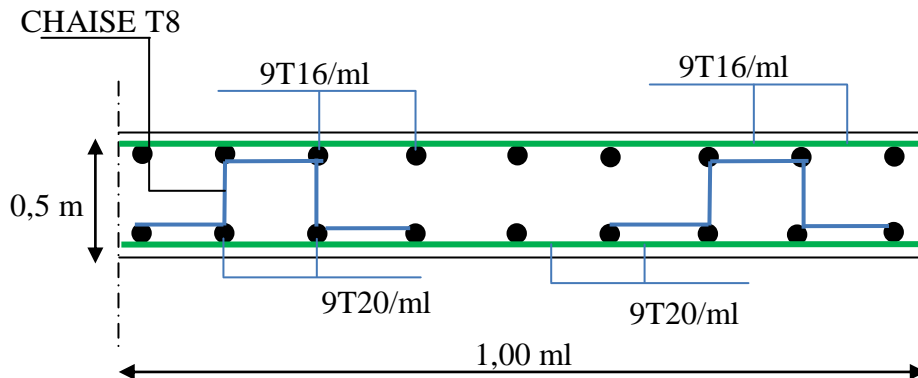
Ferrailage de la dalle du radier suivant les deux sens (x ; y)
